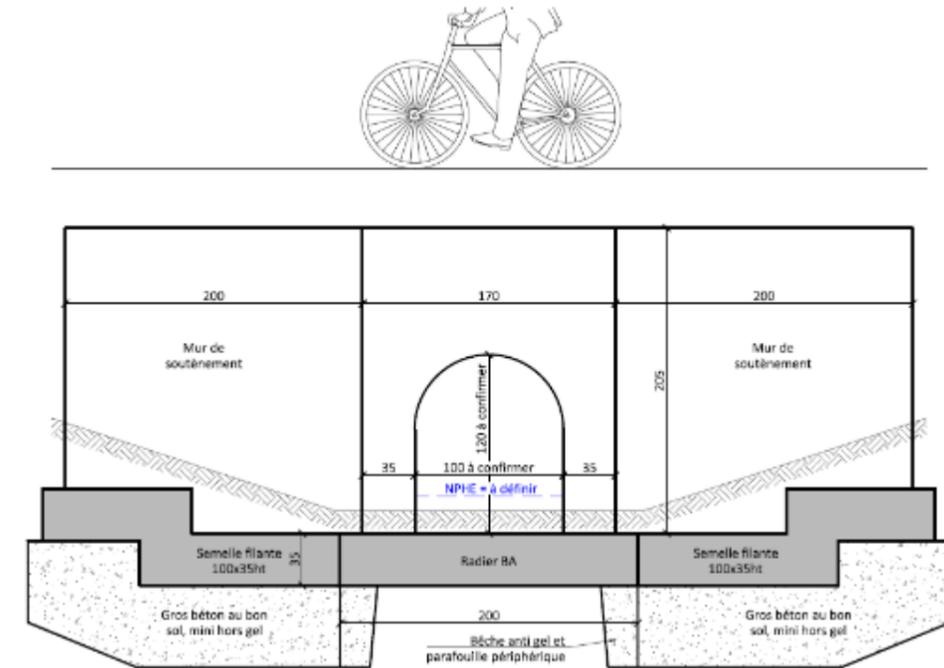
Section 2-5 - Simulation du passage sous route du bief de la Chaille
